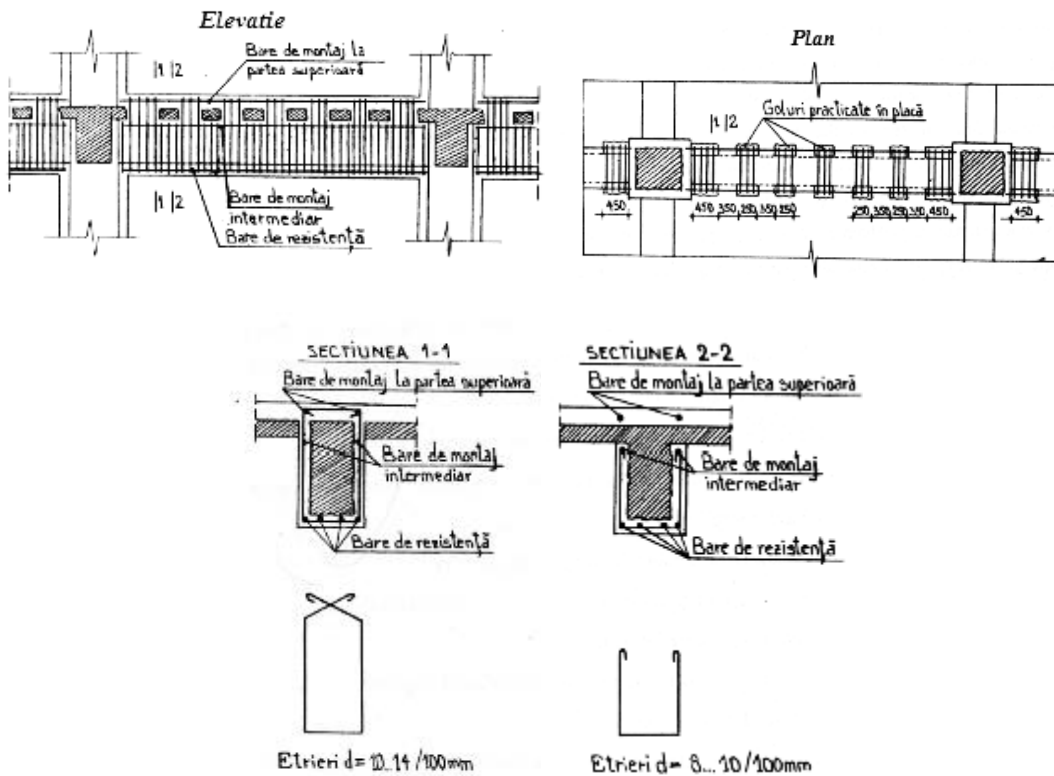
Consolidarea grinzilor din beton armat cu cămășuială pe patru laturi [66]
